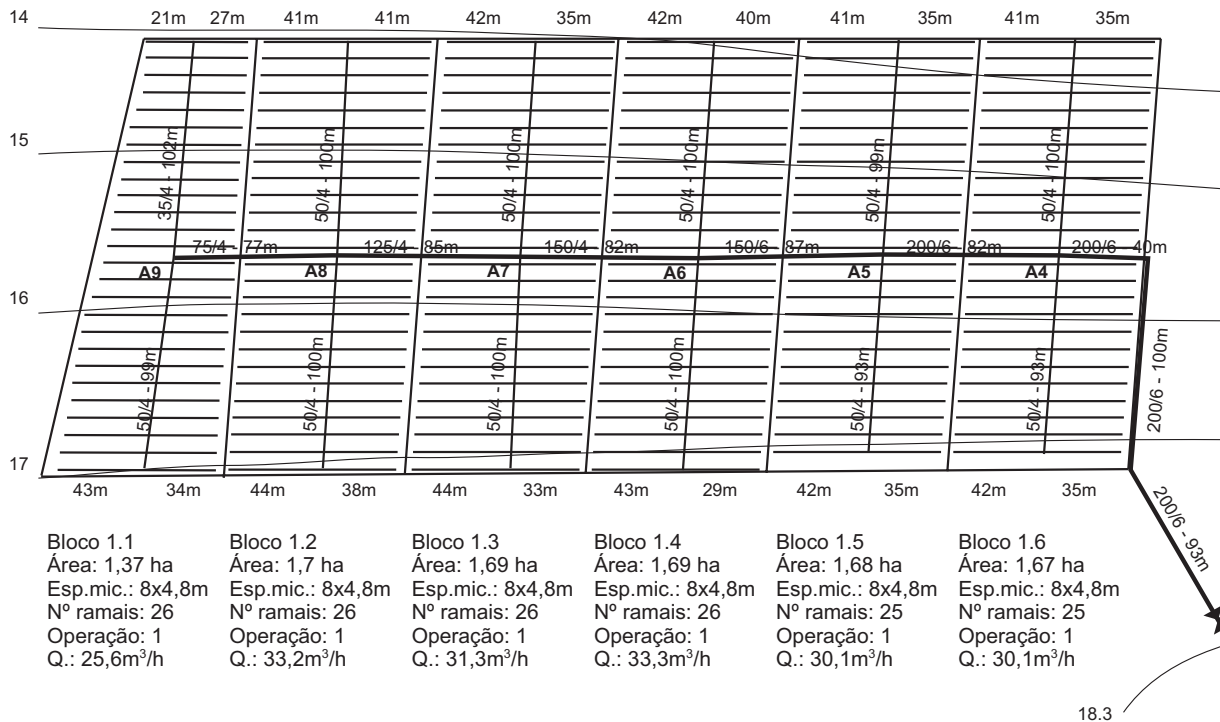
Planta-baixa do projeto de irrigação do lote nº 37.
